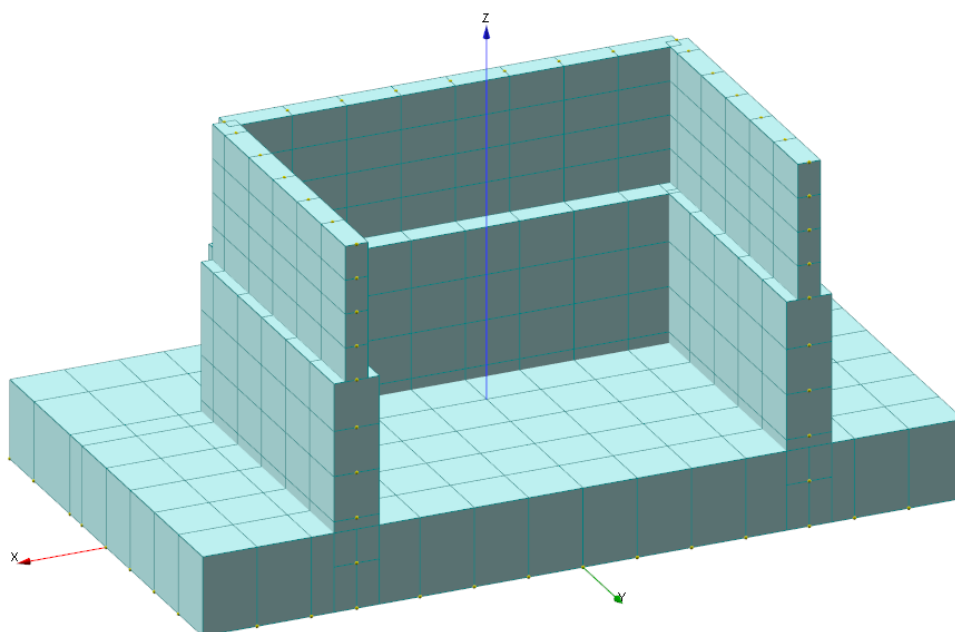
VISTA TRIDIMENSIONALE SPALLA 1 - ASSI DI RIFERIMENTO
